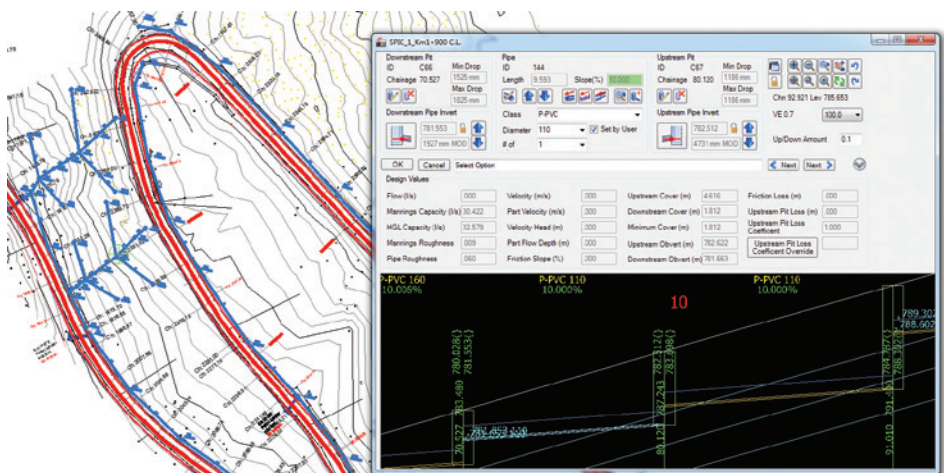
Modelarea în Civil Site Design a rețelelor de drenuri în spic
